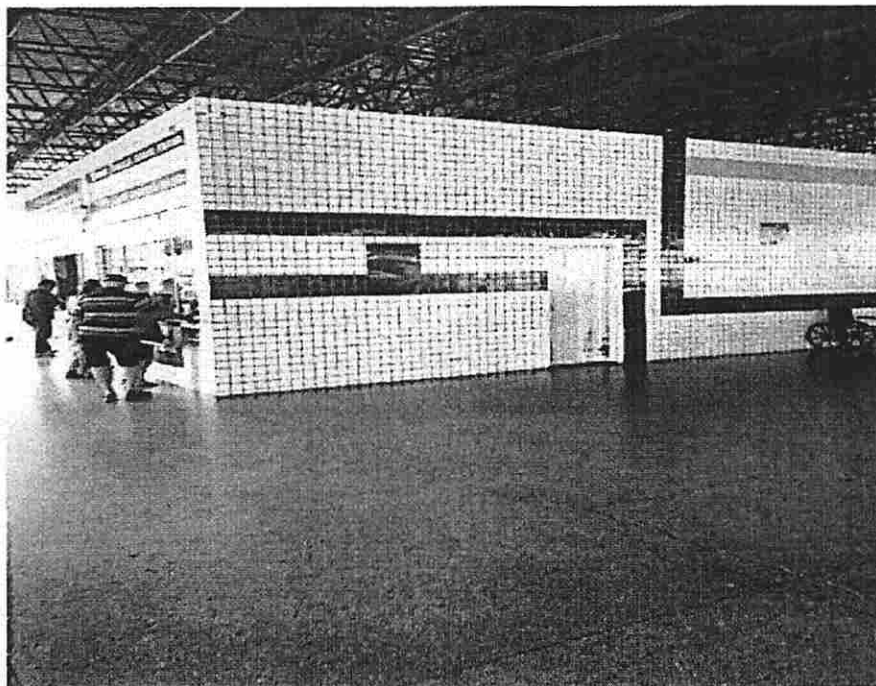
Vista de parede no saguão central com fachada moderna e acolhedora. Mostrando a limpeza do piso.
